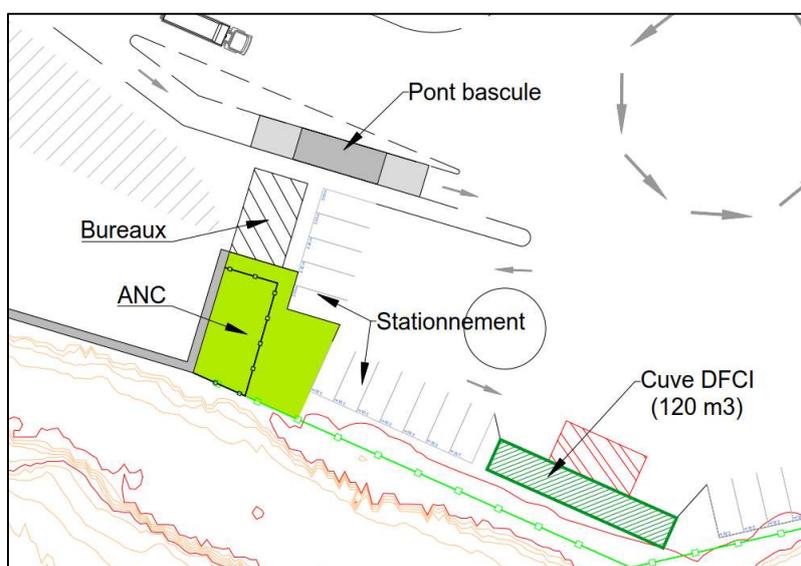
EXTRAIT DU PLAN DE MASSE SUR LA ZONE DES BUREAUX
